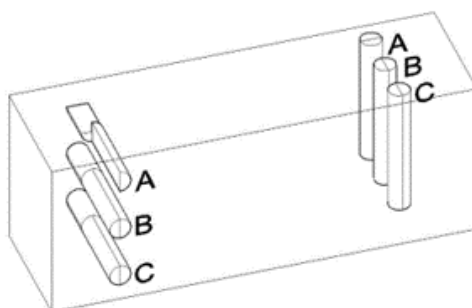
Direction de carottage dans les dalles en béton armé - Allard et al, 2016
